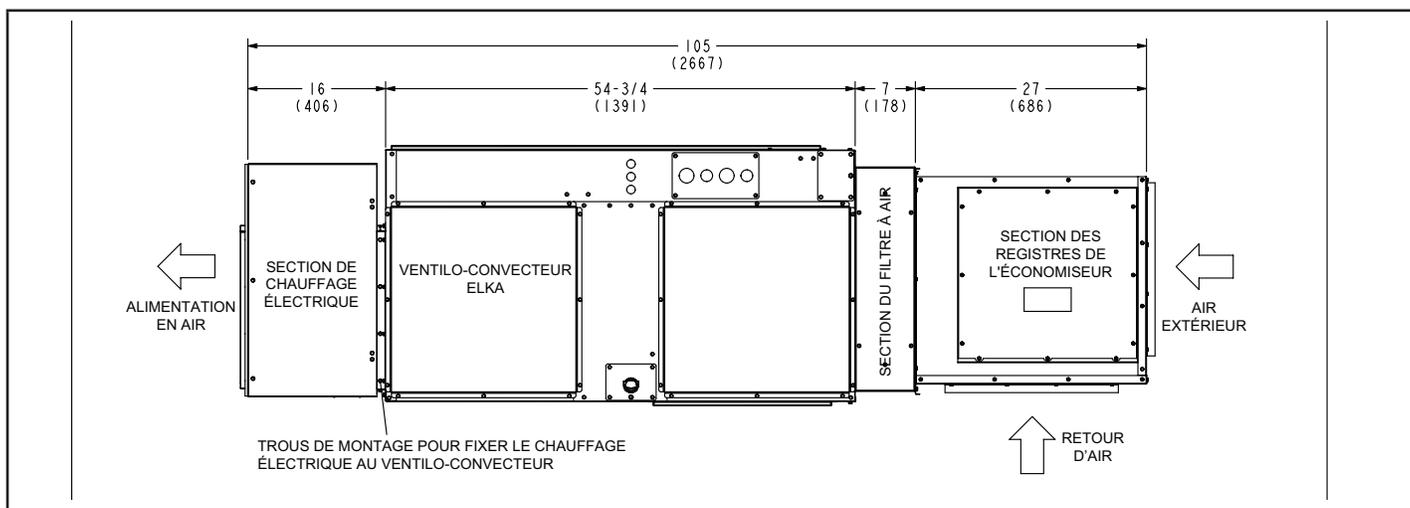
Configuration horizontale ELKA - dimensions - pouces (mm)
